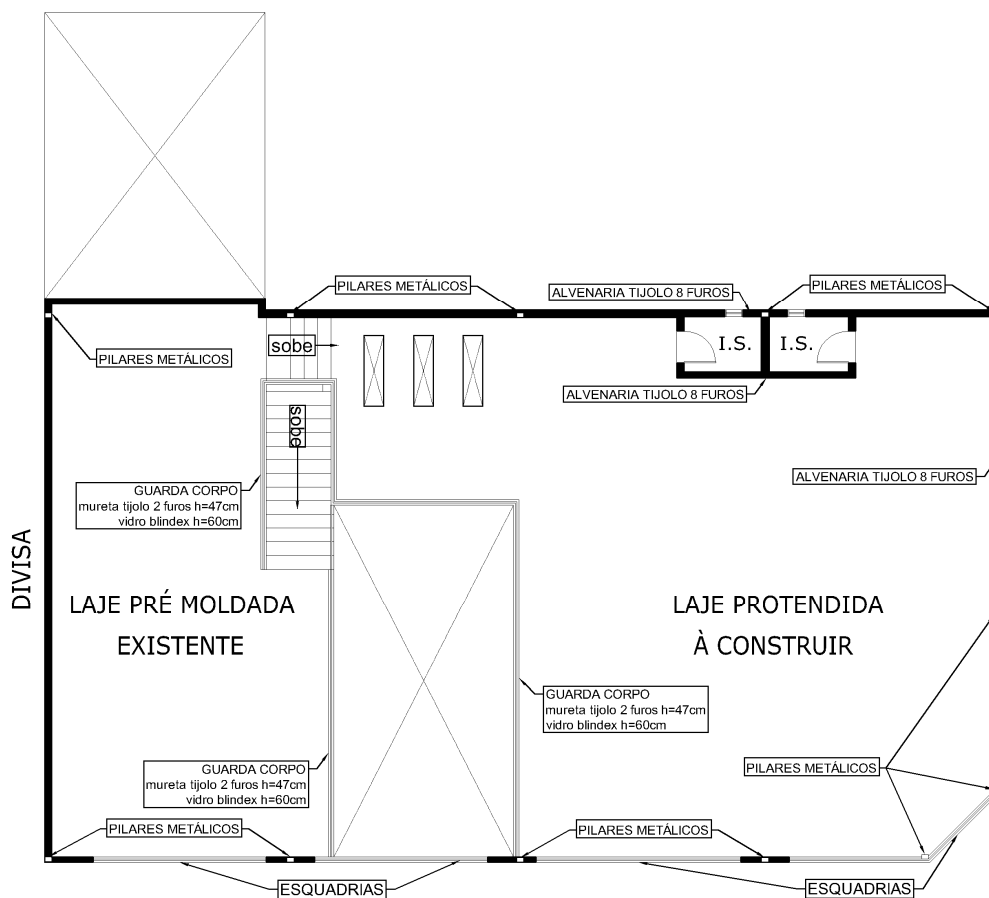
PLANTA DE AMPLIAÇÃO (SEGUNDO PAVIMENTO)
